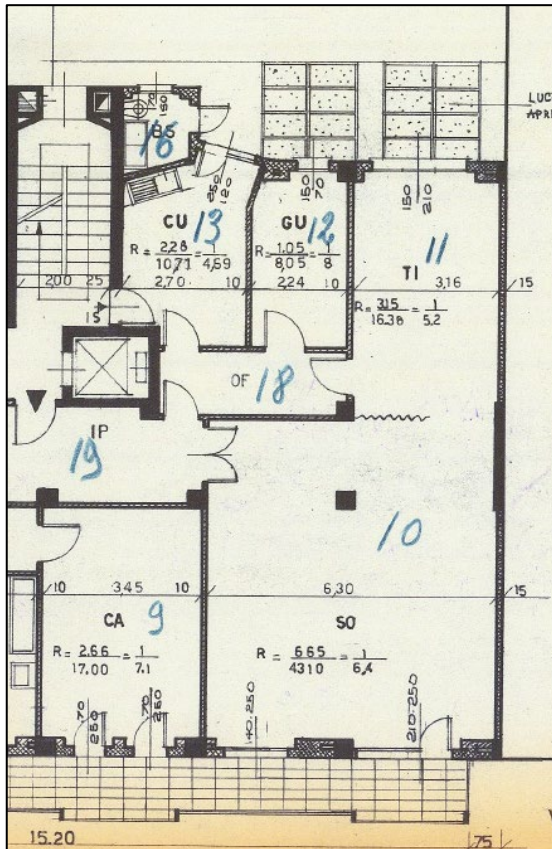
Pianta p.1° - aggiornata al 12.10.1965
